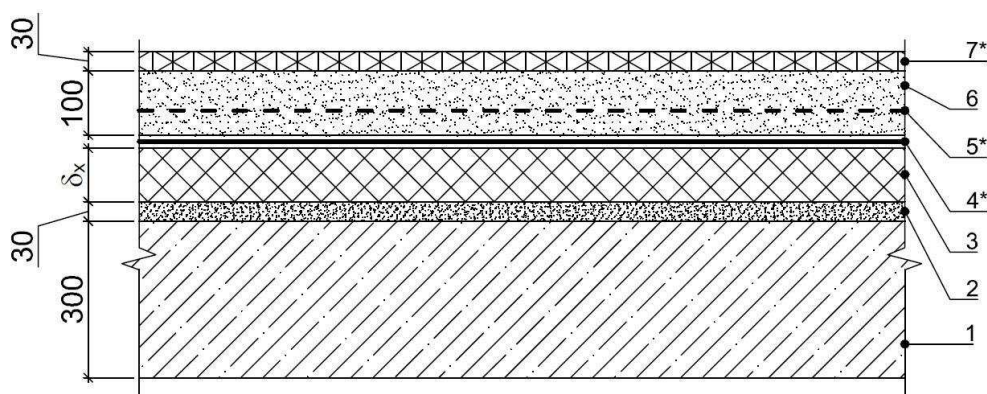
Конструкция перекрытия над неотапливаемым подвалом, проездом или по грунту
